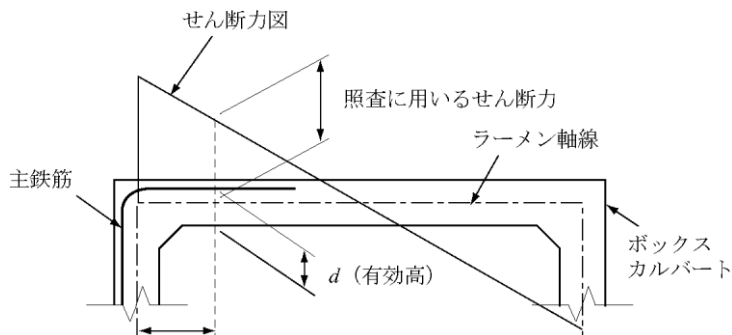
せん断力に対する照査位置（ラーメン形状）
